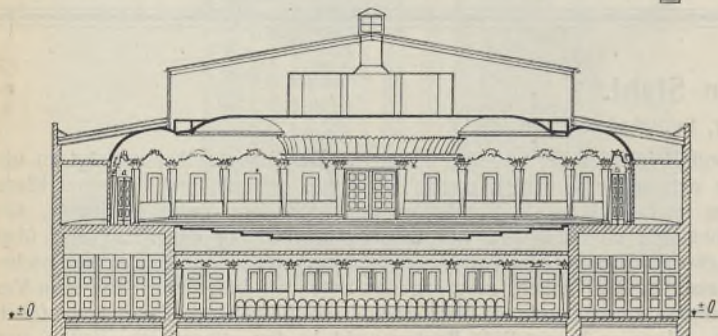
Querschnitt nach dem Rang zu gesehen.
